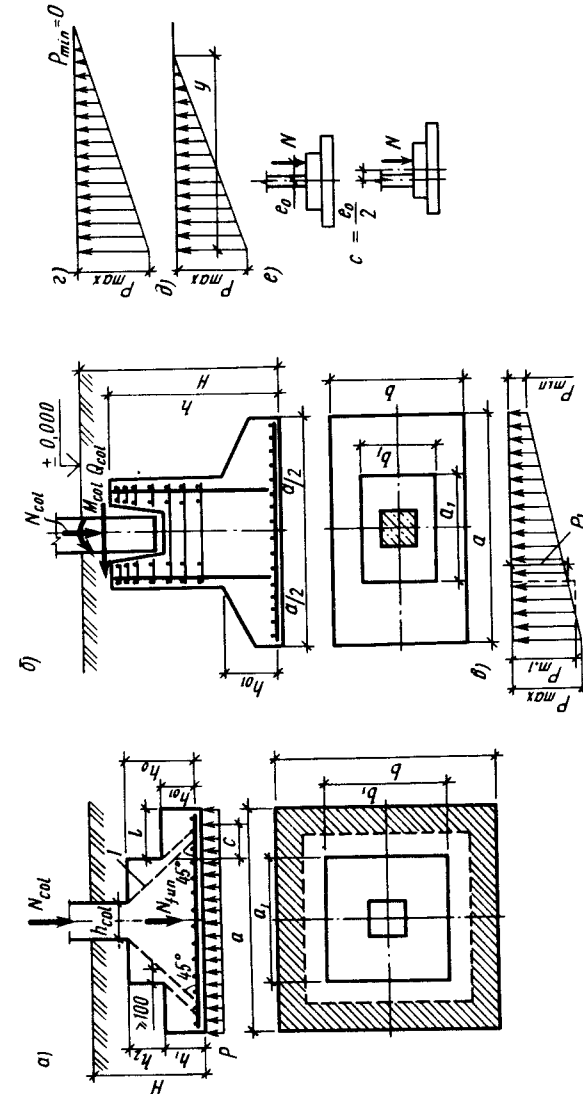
К расчету отдельных фундаментов: а — центрально-нагруженный; б — внецентренно нагруженный; в...д — максимальное крайнее давление фундаментов на грунт соответственно в зданиях с мостовым краном грузоподъемностью более 75 т, менее 75 т и без кранов; е — параметр уменьшения эксцентриситета путем смещения фундамента относительно колонны
